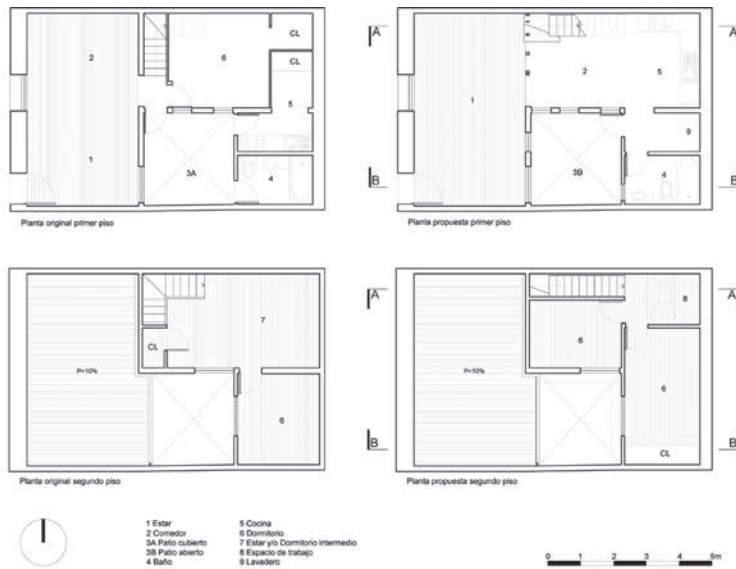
Planimetría estado anterior y propuesta proyecto. Fuente: Elaboración propia.
